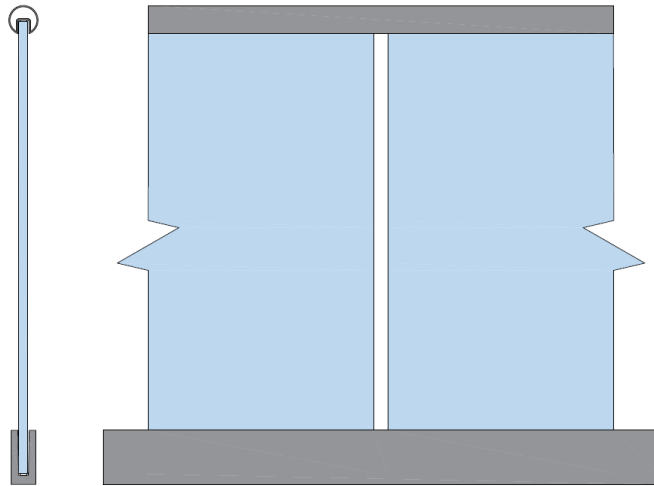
Variante β : Ausführung mit durchgehendem Handlauf
